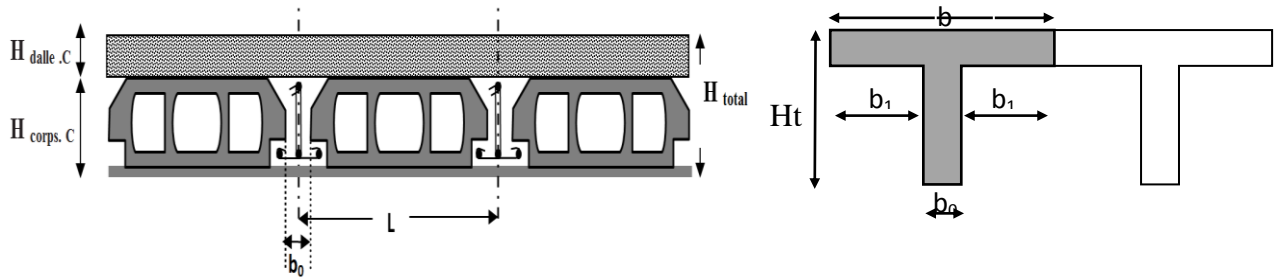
2. Coupe transversale sur un plancher à corps creux
